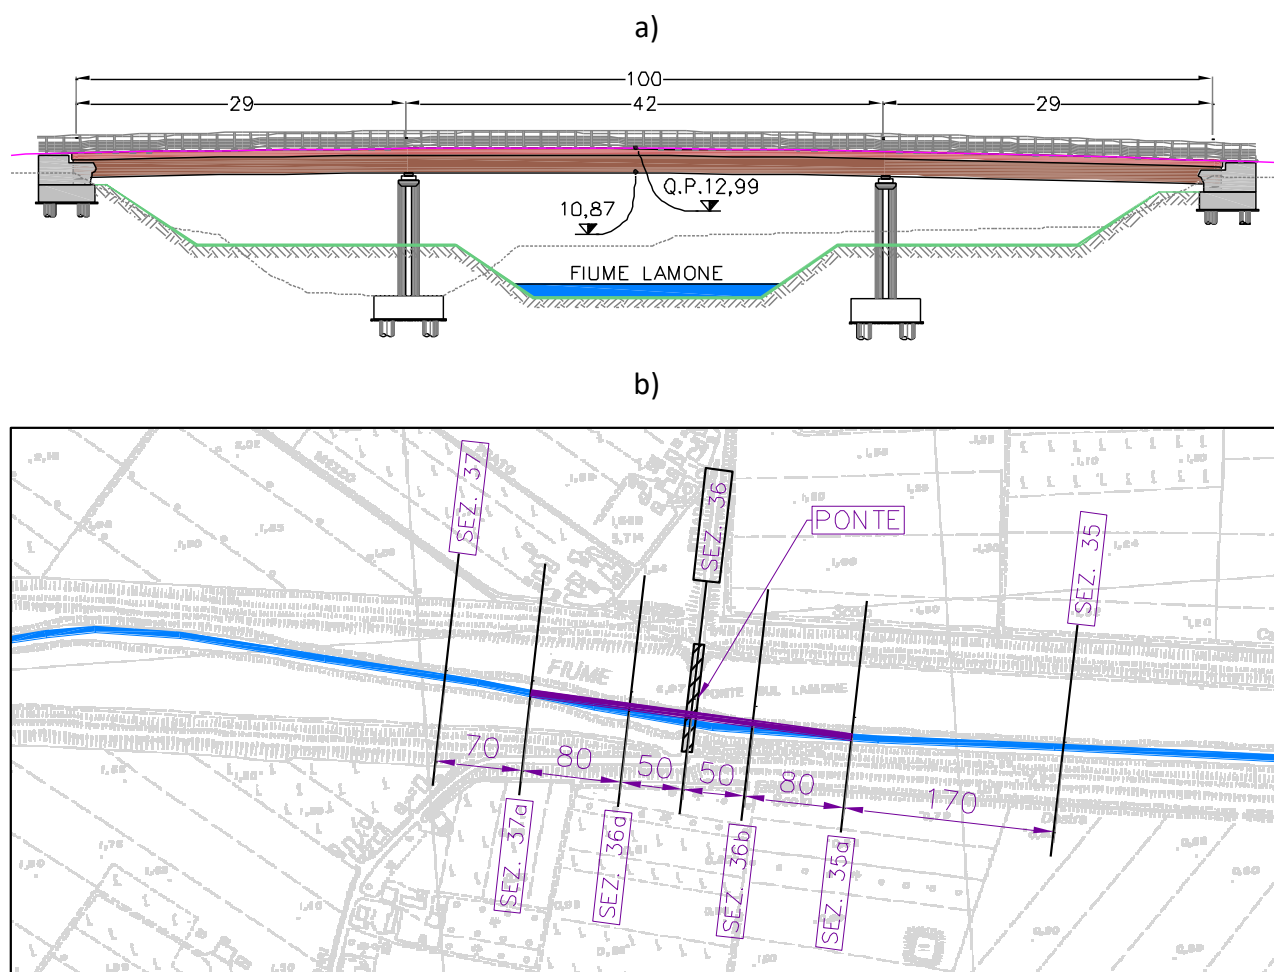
a) Quote di progetto del nuovo ponte; b) schema planimetrico della sistemazione dell'alveo
